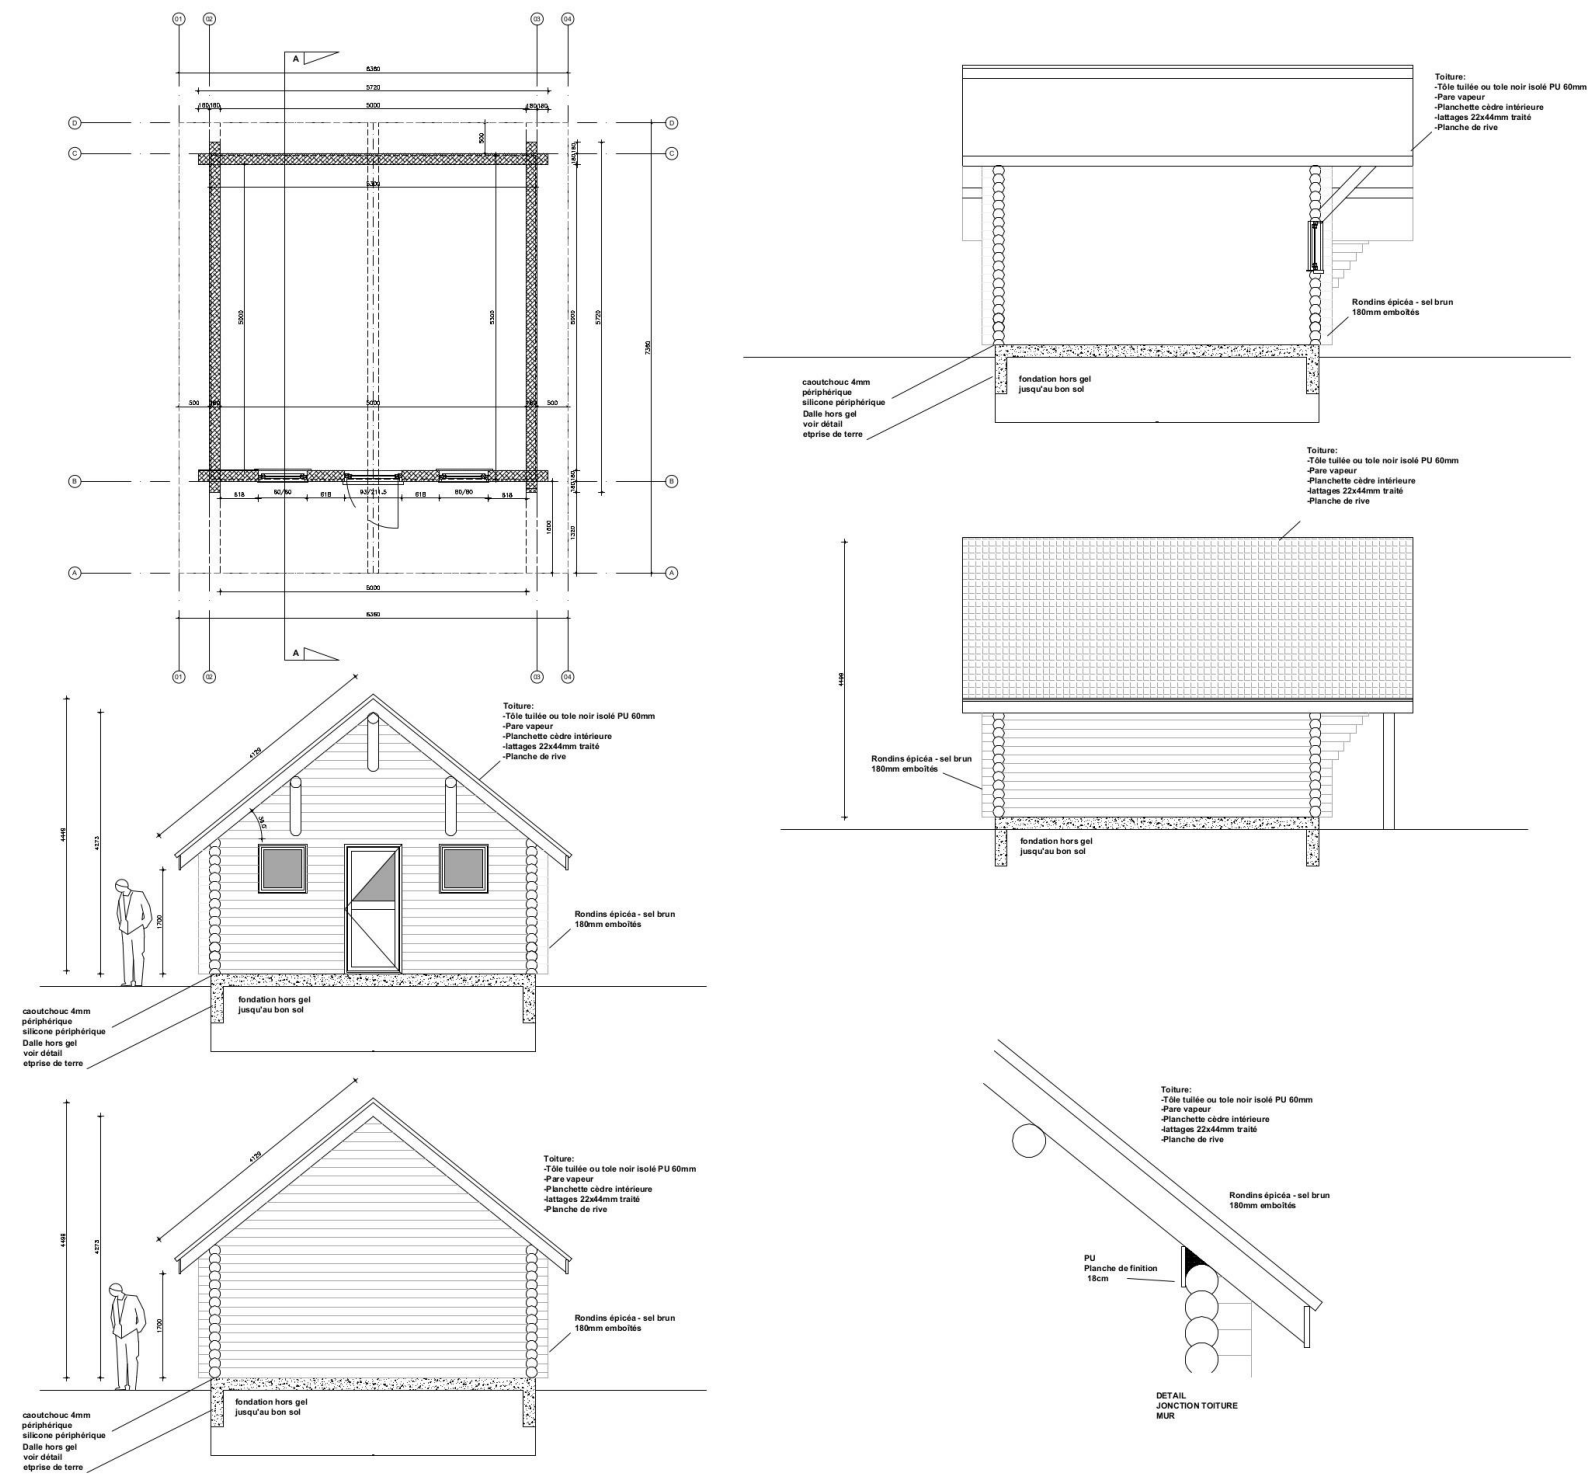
Grondplan A-frame gebouw (A2S-Architecten)
